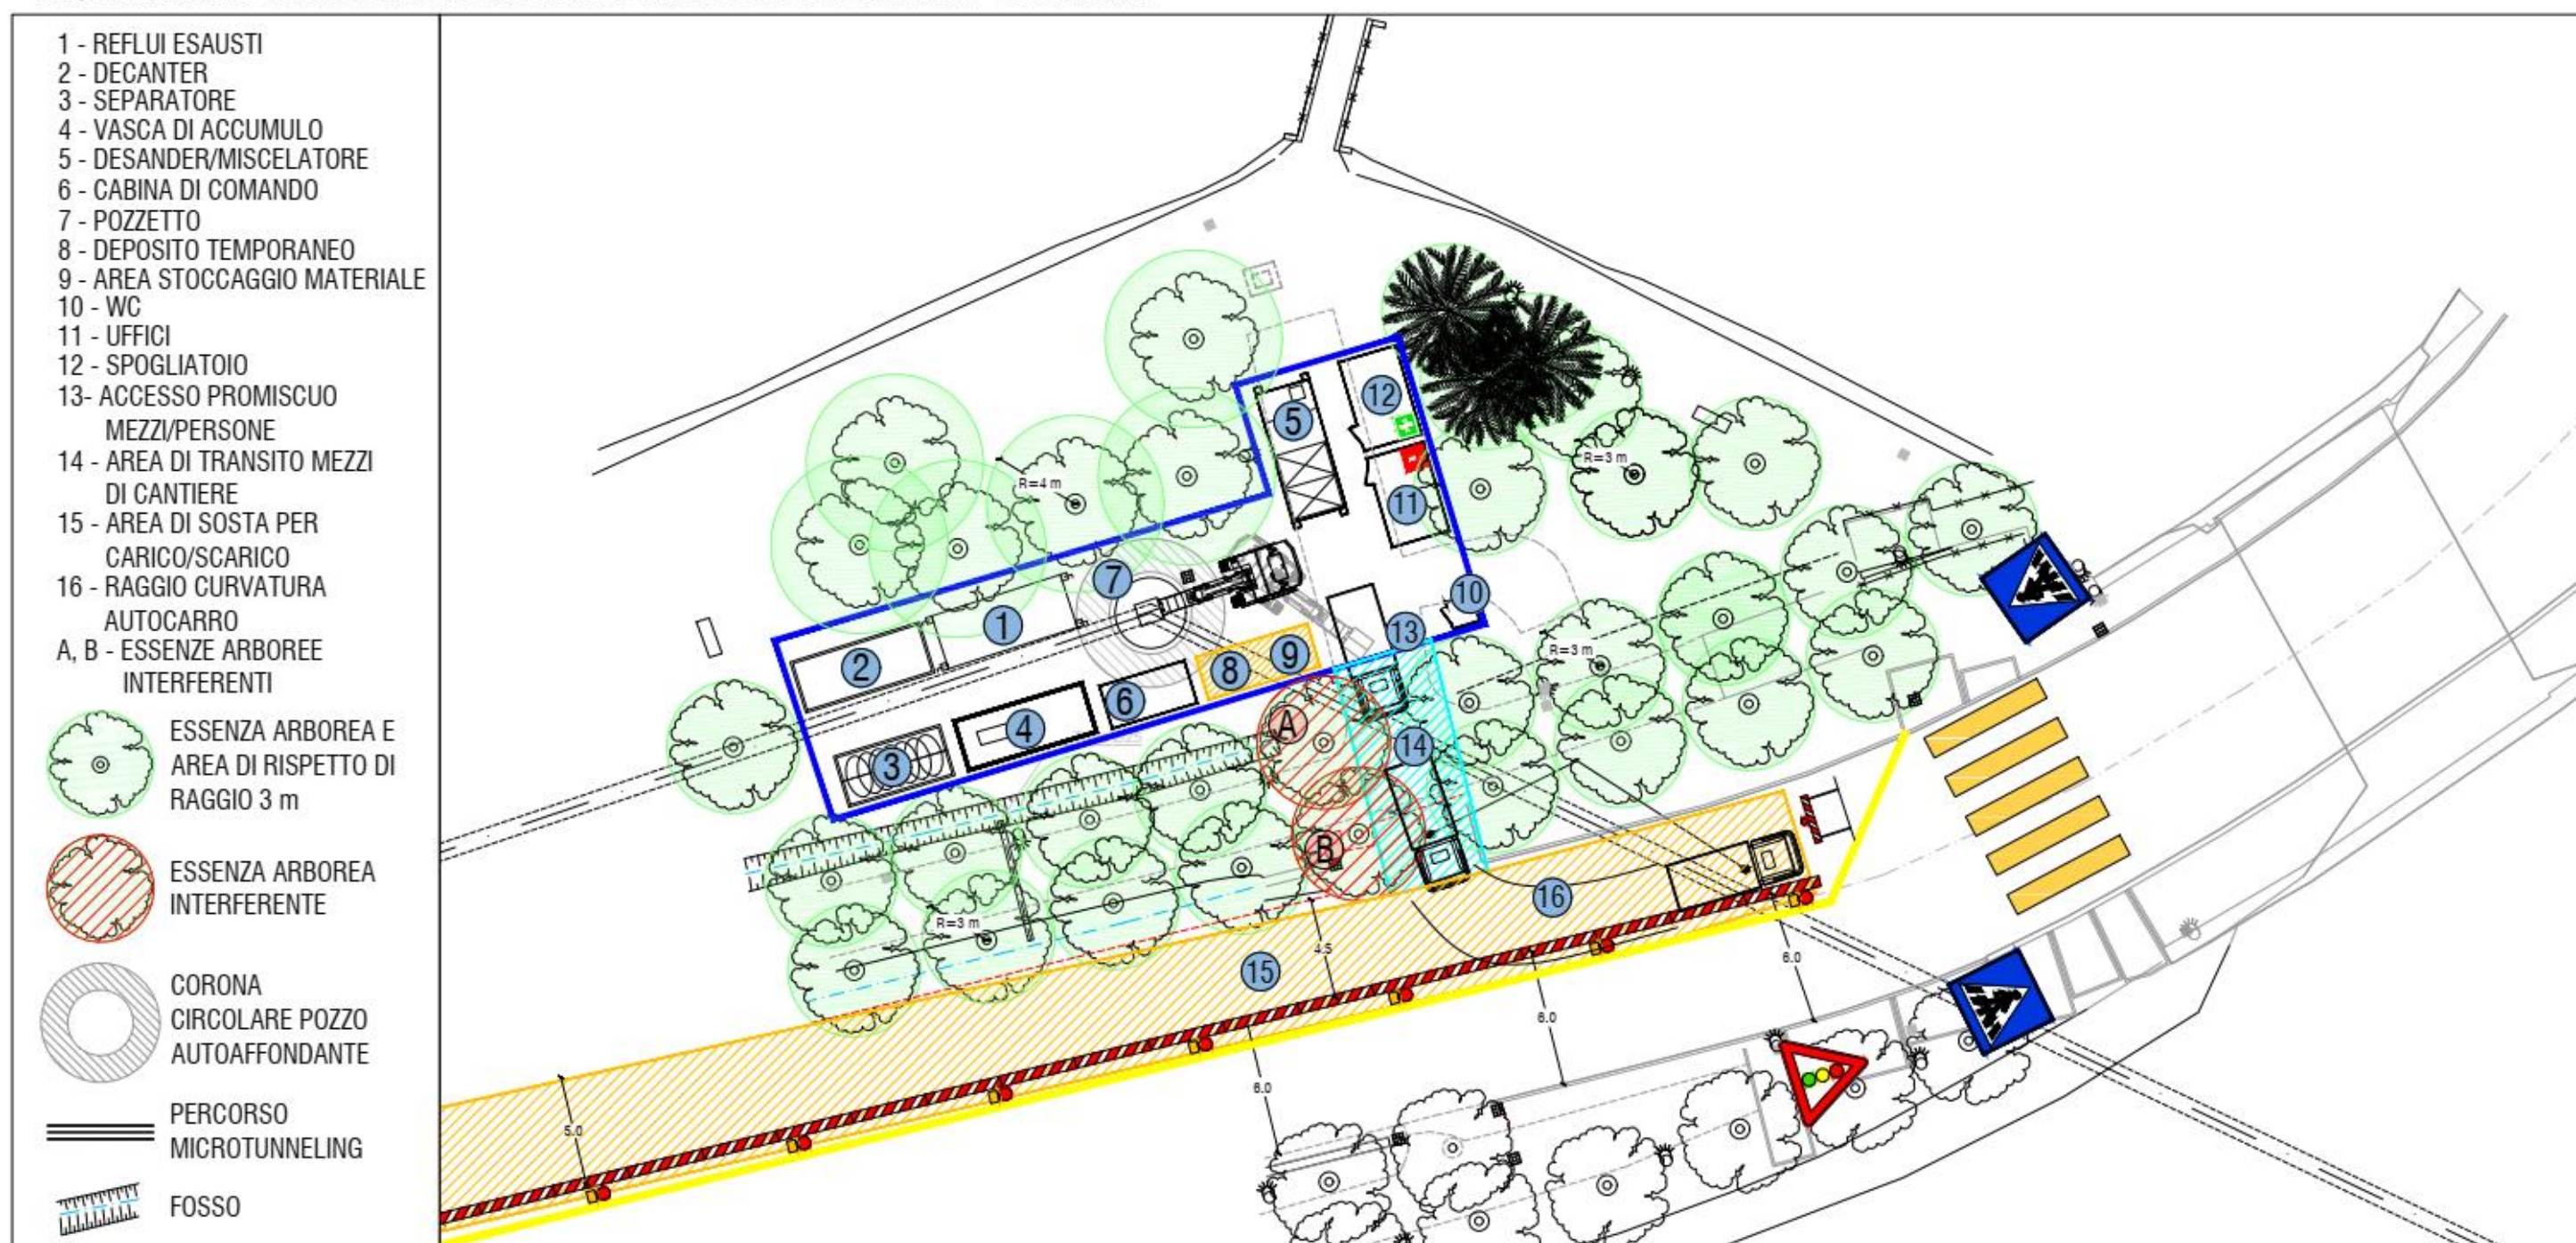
S : Inquadramento planimetrico area cantiere POZZO S03
